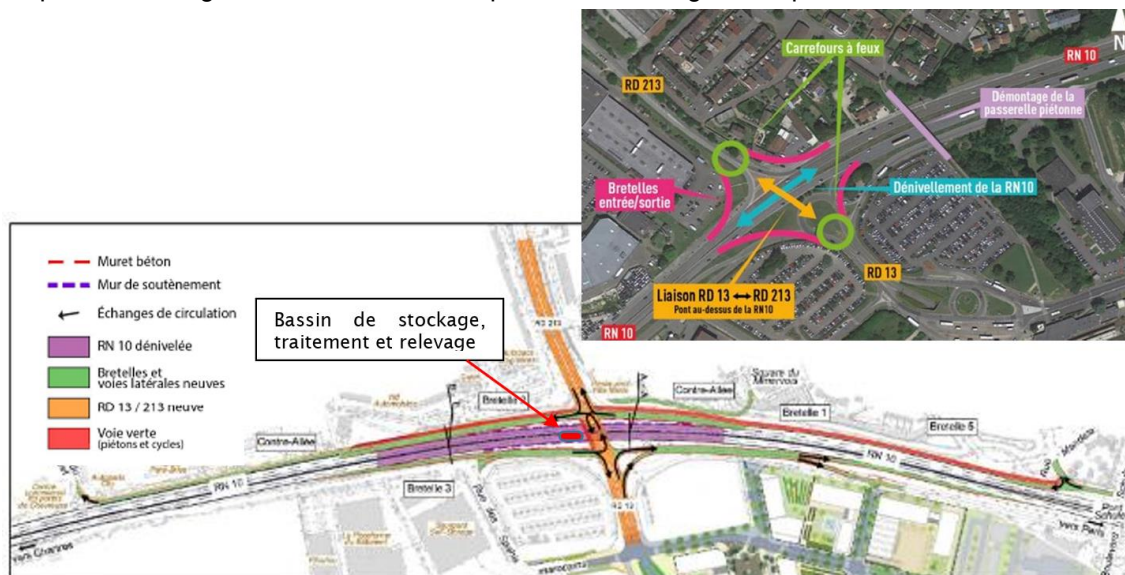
Plan d'aménagement (Etude d'impact du projet, 2023).
